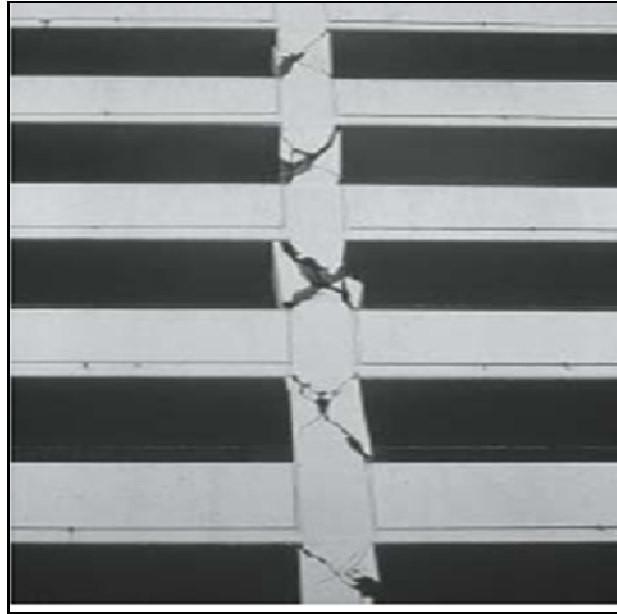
Effondrement des poteaux courts par cisaillement de ce parking (Northridge, Californie, 1994).
